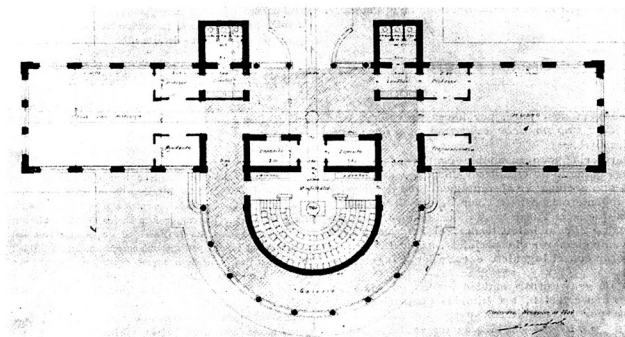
Pabellón de Anatomía y Disección, planta alta del proyecto.
